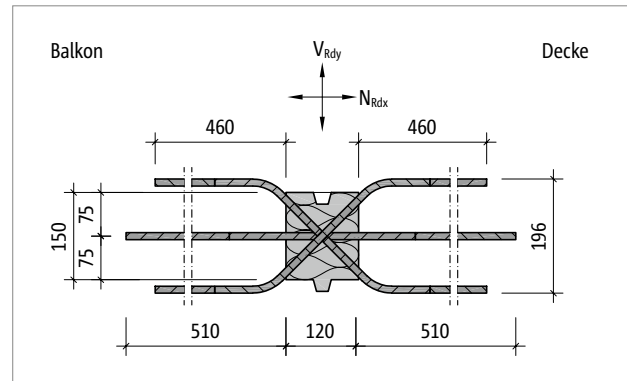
Schöck Isokorb® XT Typ H-VV2-NN1: Produktgrundriss
